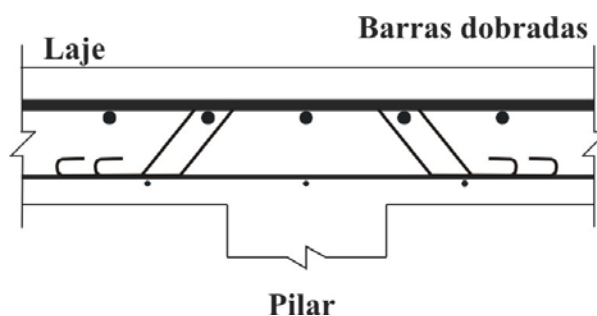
Armadura de cisalhamento tipo barra dobrada
